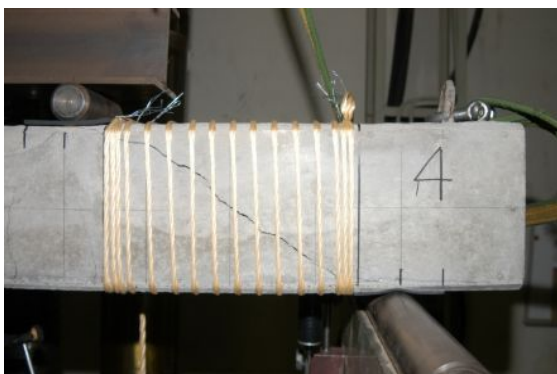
終局時のひび割れ状況 (No. 6)
